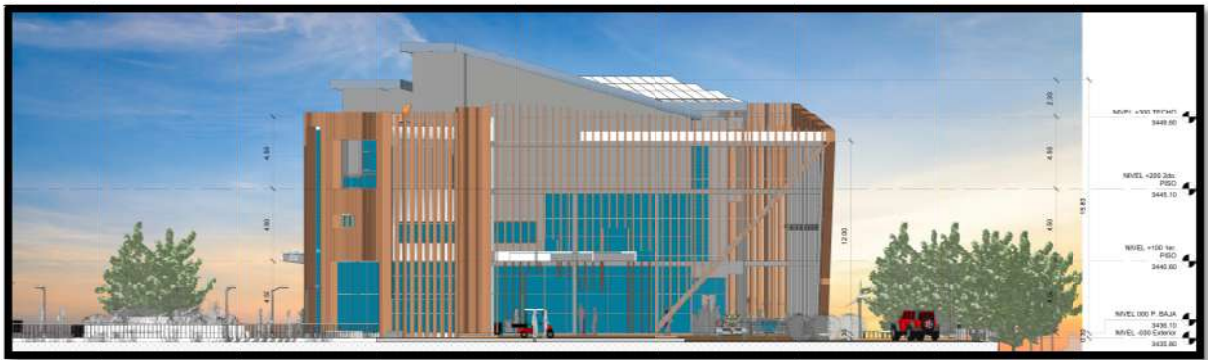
FACHADA 2 - VISTA SUROESTE
